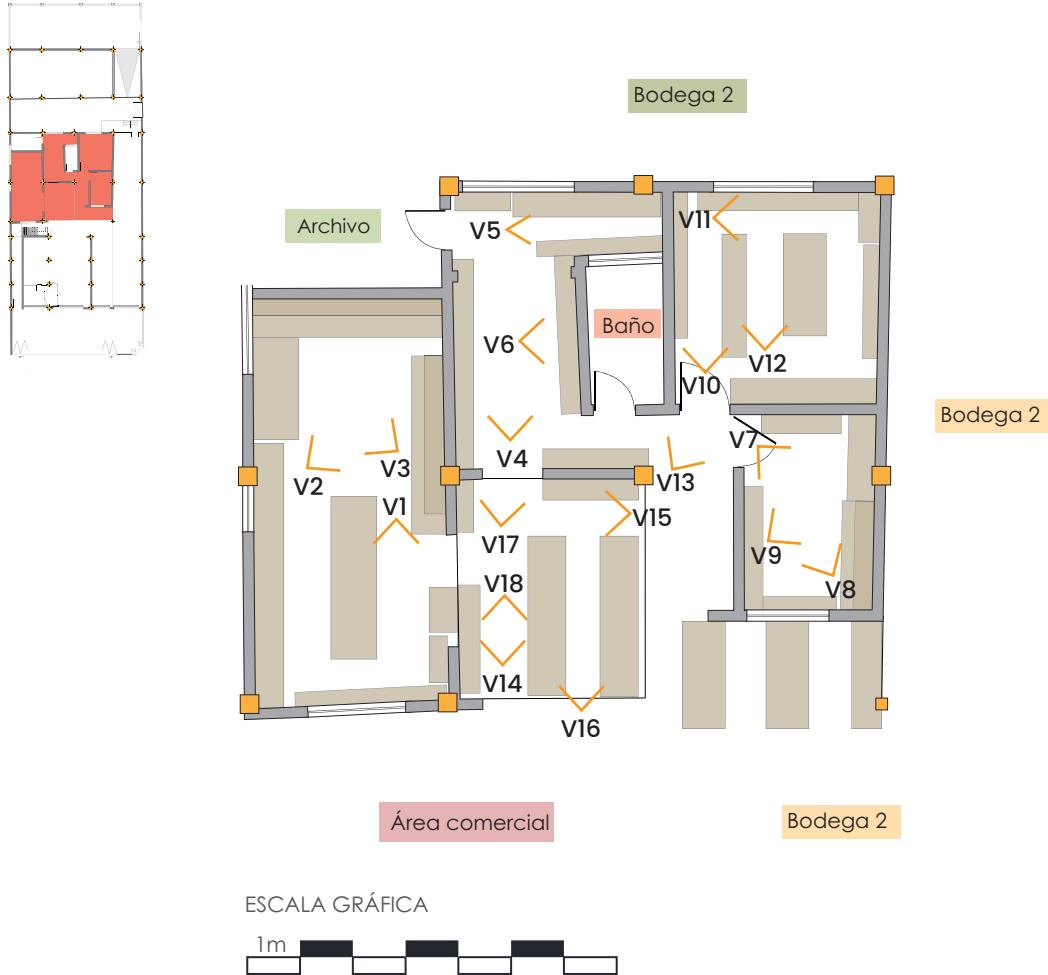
Ubicación en planta y planta detalle de la Bodega 1.
